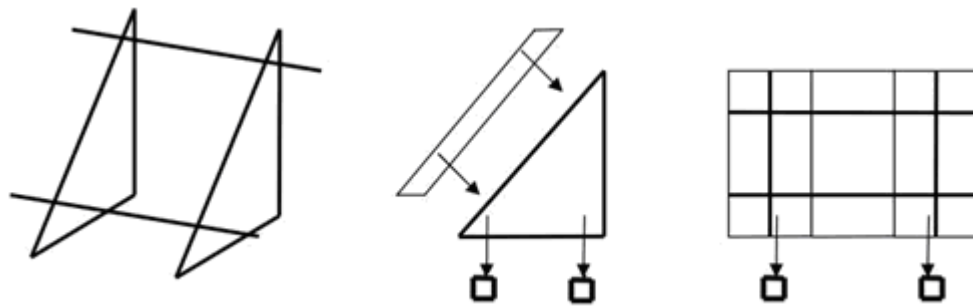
Схема опорной конструкции на отдельных бетонных опорах
